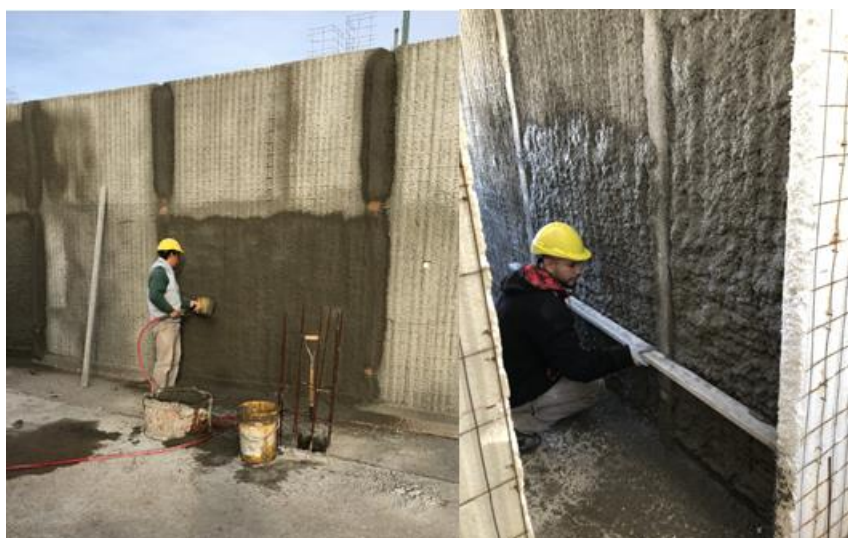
Proyectado de mortero estructural sobre planta baja.
